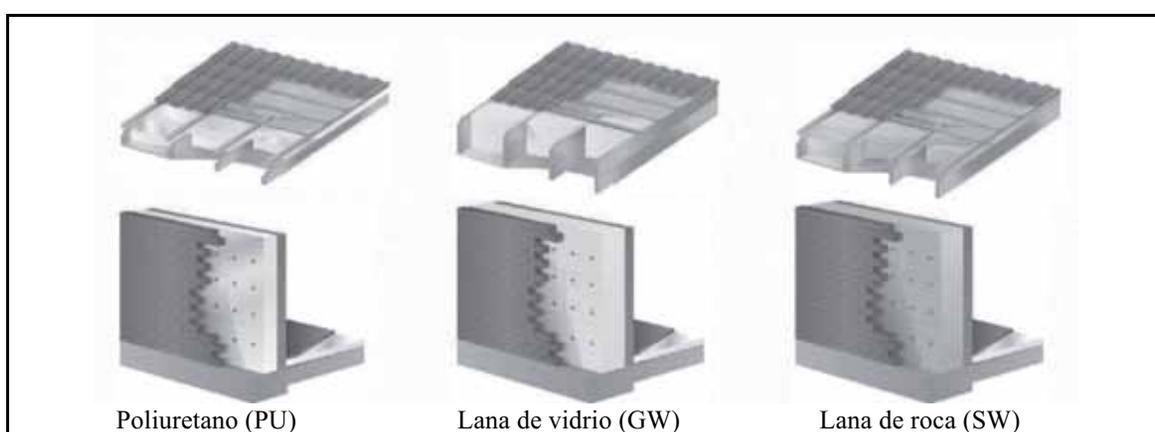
Soluciones constructivas para aislamiento de cubiertas inclinadas y fachadas con cámara mostrando la relación real de espesor de aislamiento
